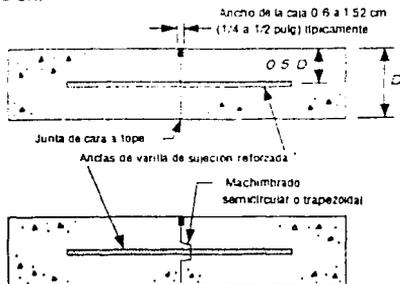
JUNTA LONGITUDINAL DE CONSTRUCCIÓN.
